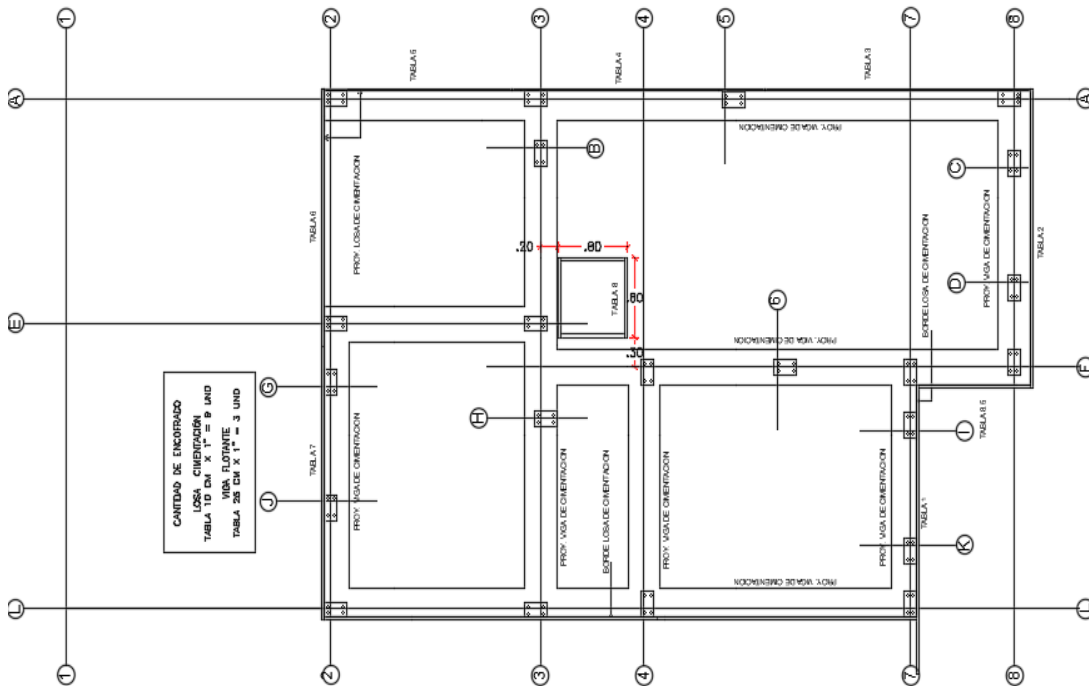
Planta de losa de cimentación y distribución de columnas
